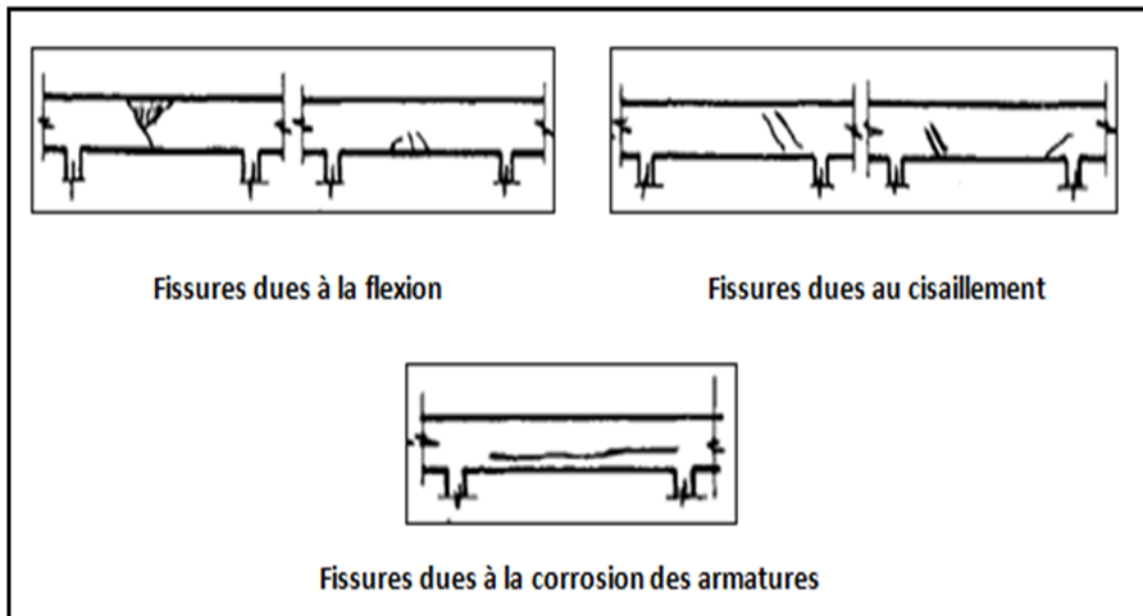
Fissures qui apparaissent dans les poutres en BA.
